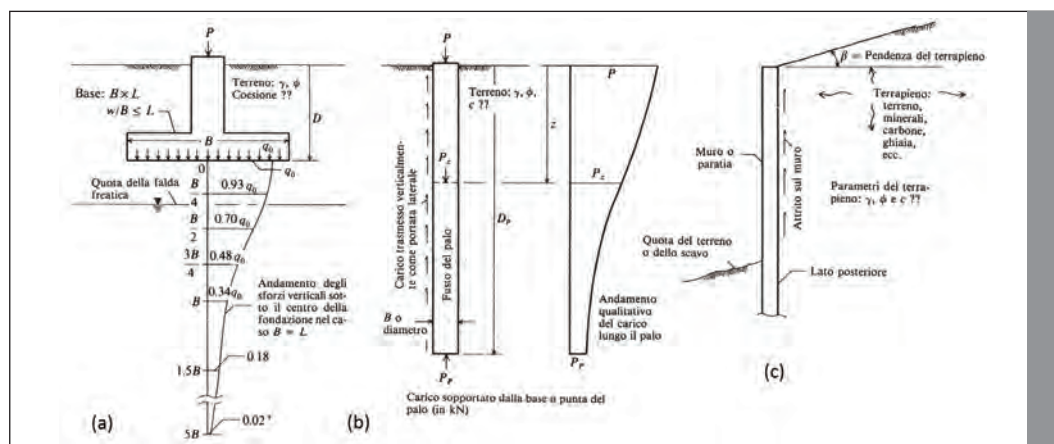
(a) Fondazione diffusa; (b) Palo di fondazione; (c) Struttura di contenimento.
